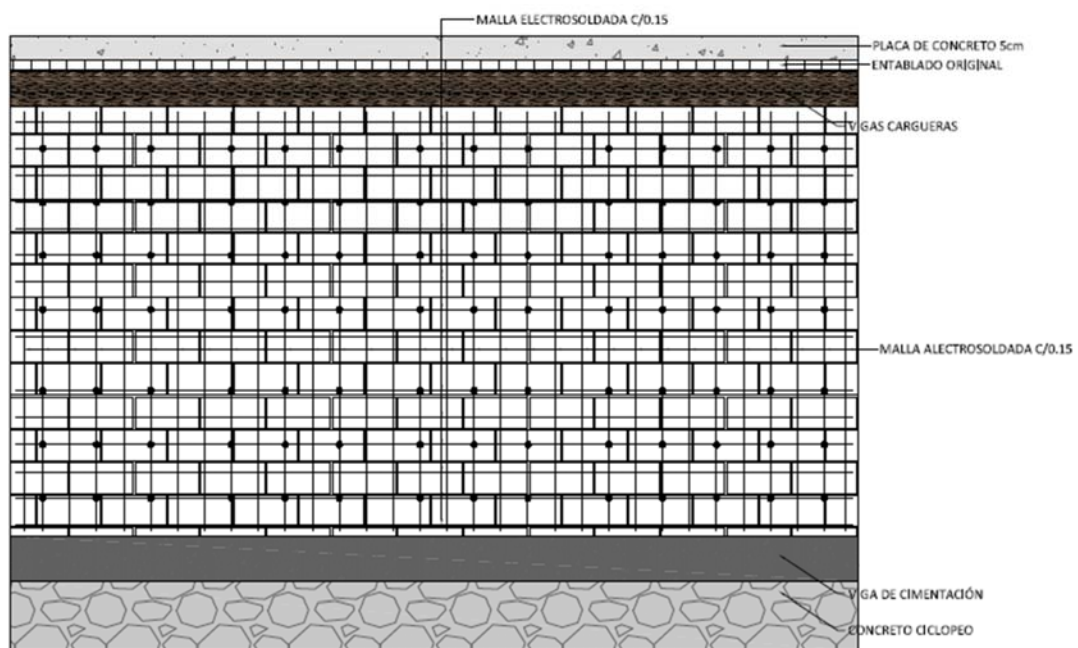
RE - Detalle general de muros para reforzamiento
